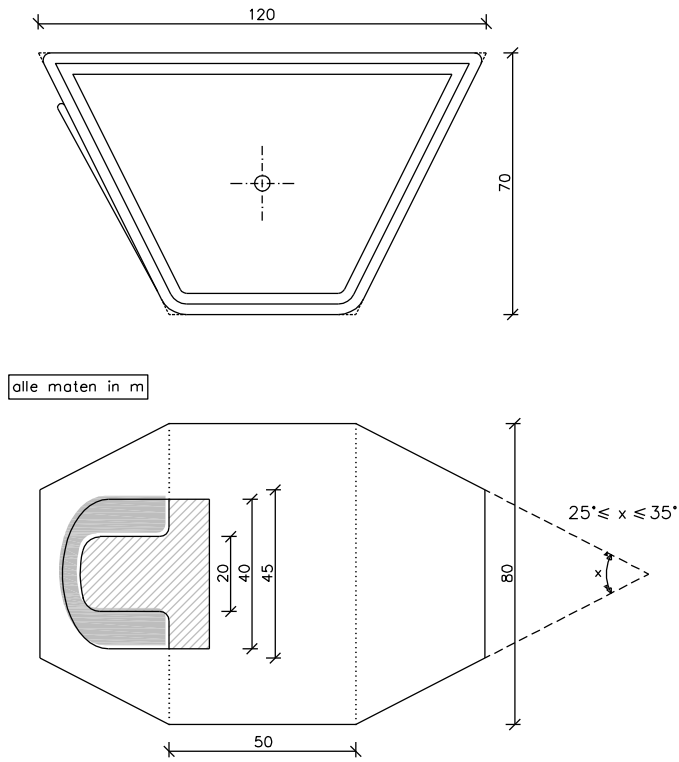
wegafbakeningselement voor metalen afschermdende constructie – type a
